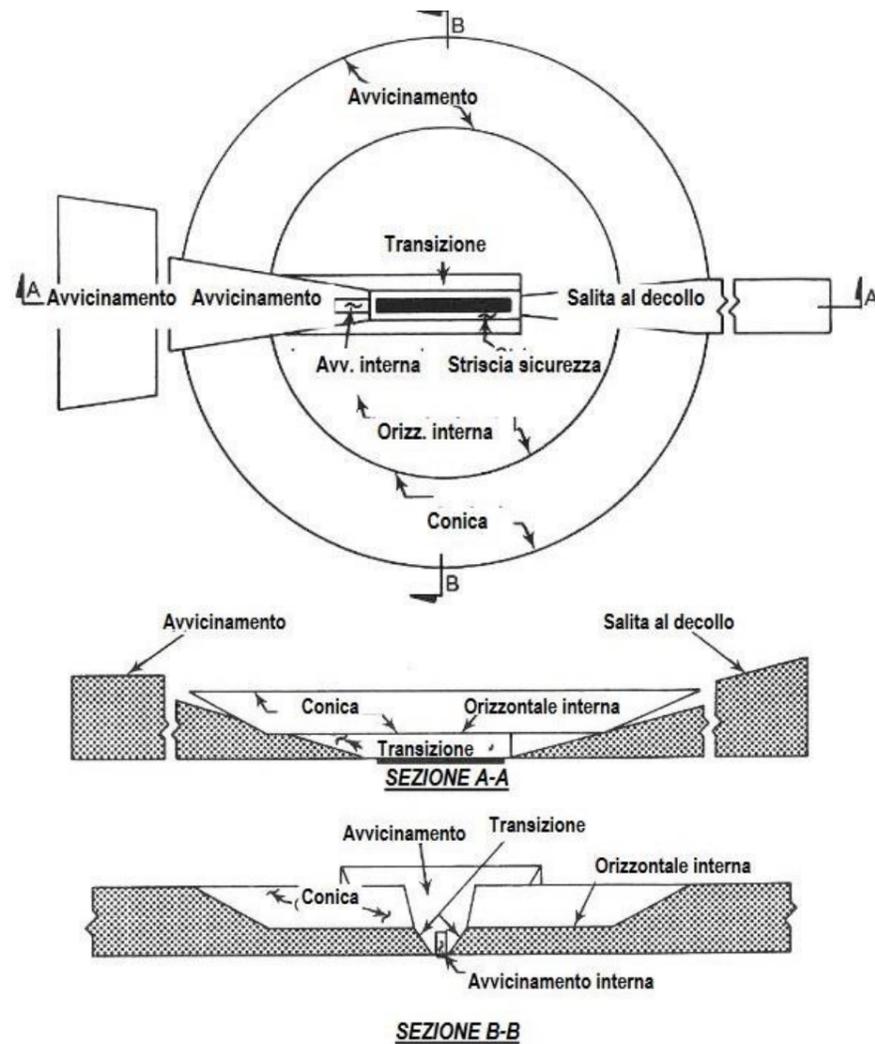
Schema generale delle superfici di rispetto degli ostacoli (Fonte: ENAC)
